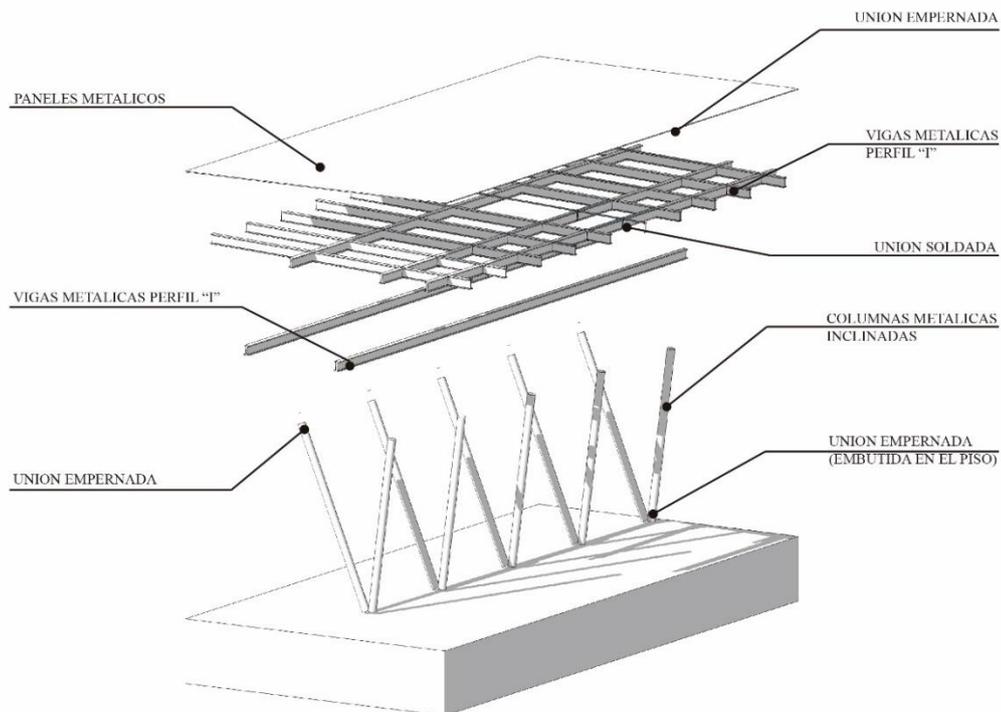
Detalle de Columnas, y techo en los andenes de la Estación Cuatro Caminos.
